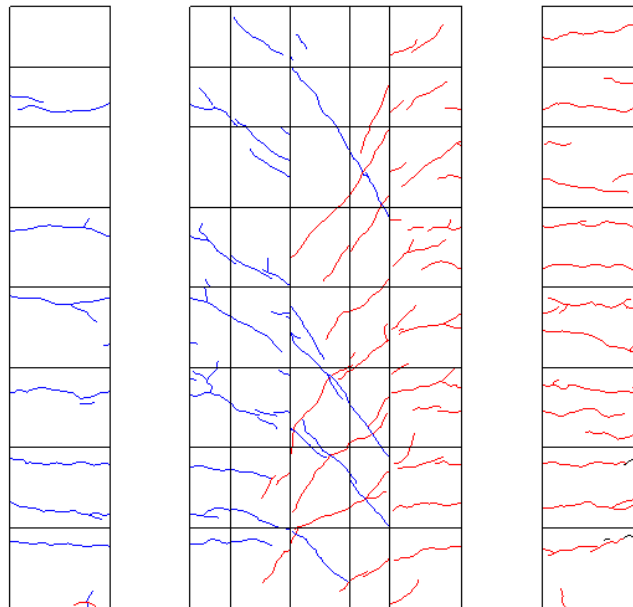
R=-1/133②ひび割れ図
